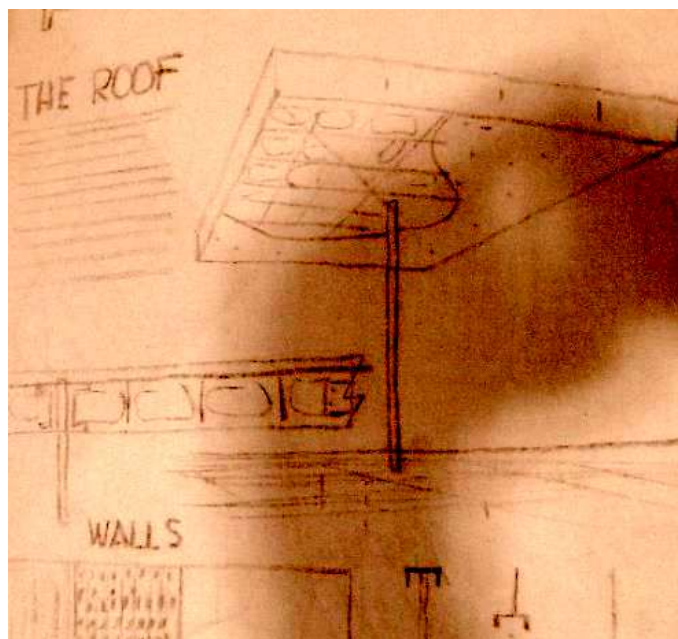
Detalle parasol House, unidad estructural de la cubierta.
